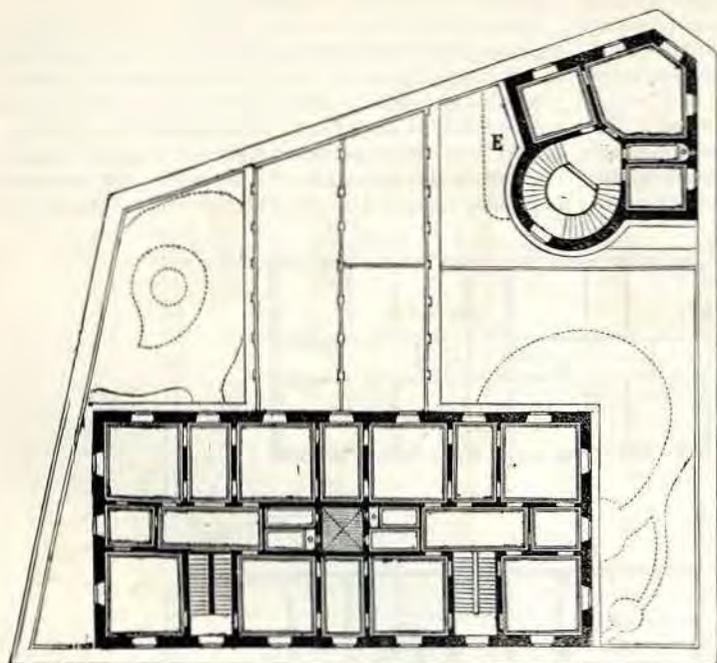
Isolato N° V, Villini. Pianta del primo piano. Scala di 1 : 420.
